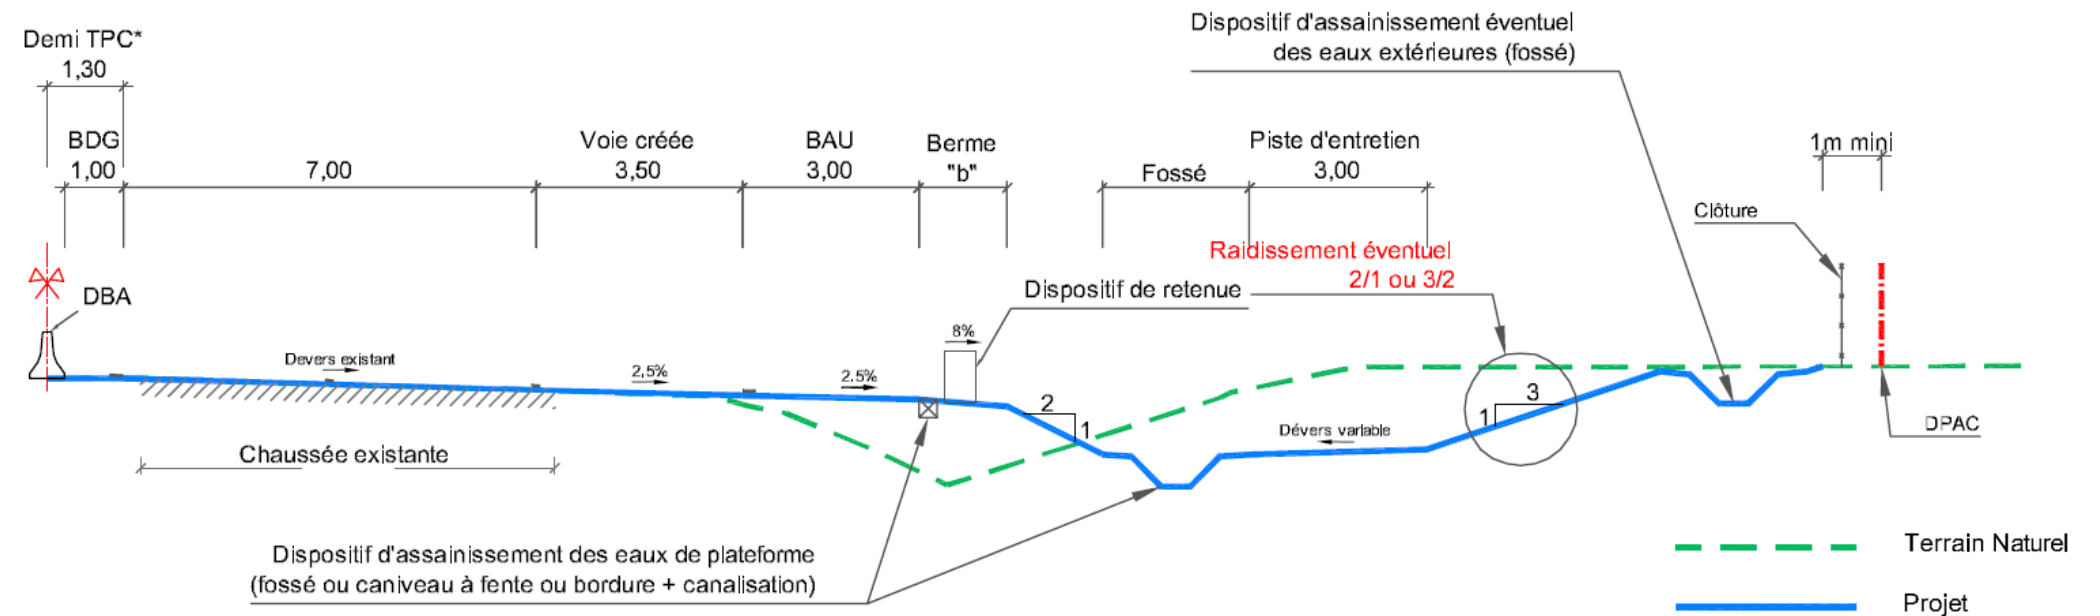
Profil en travers type après travaux : configuration de l'autoroute en déblais
